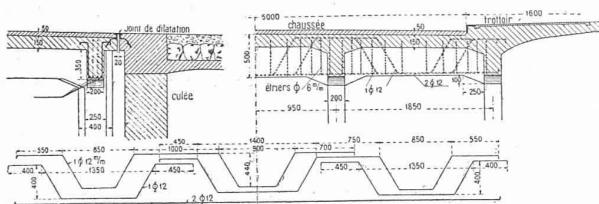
Armature des poutres transversales aux 2 extrémités du pont.
